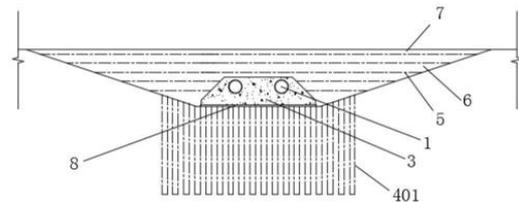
图 1 管床段垂直于管道方面横剖面图 (CC 剖面图)
